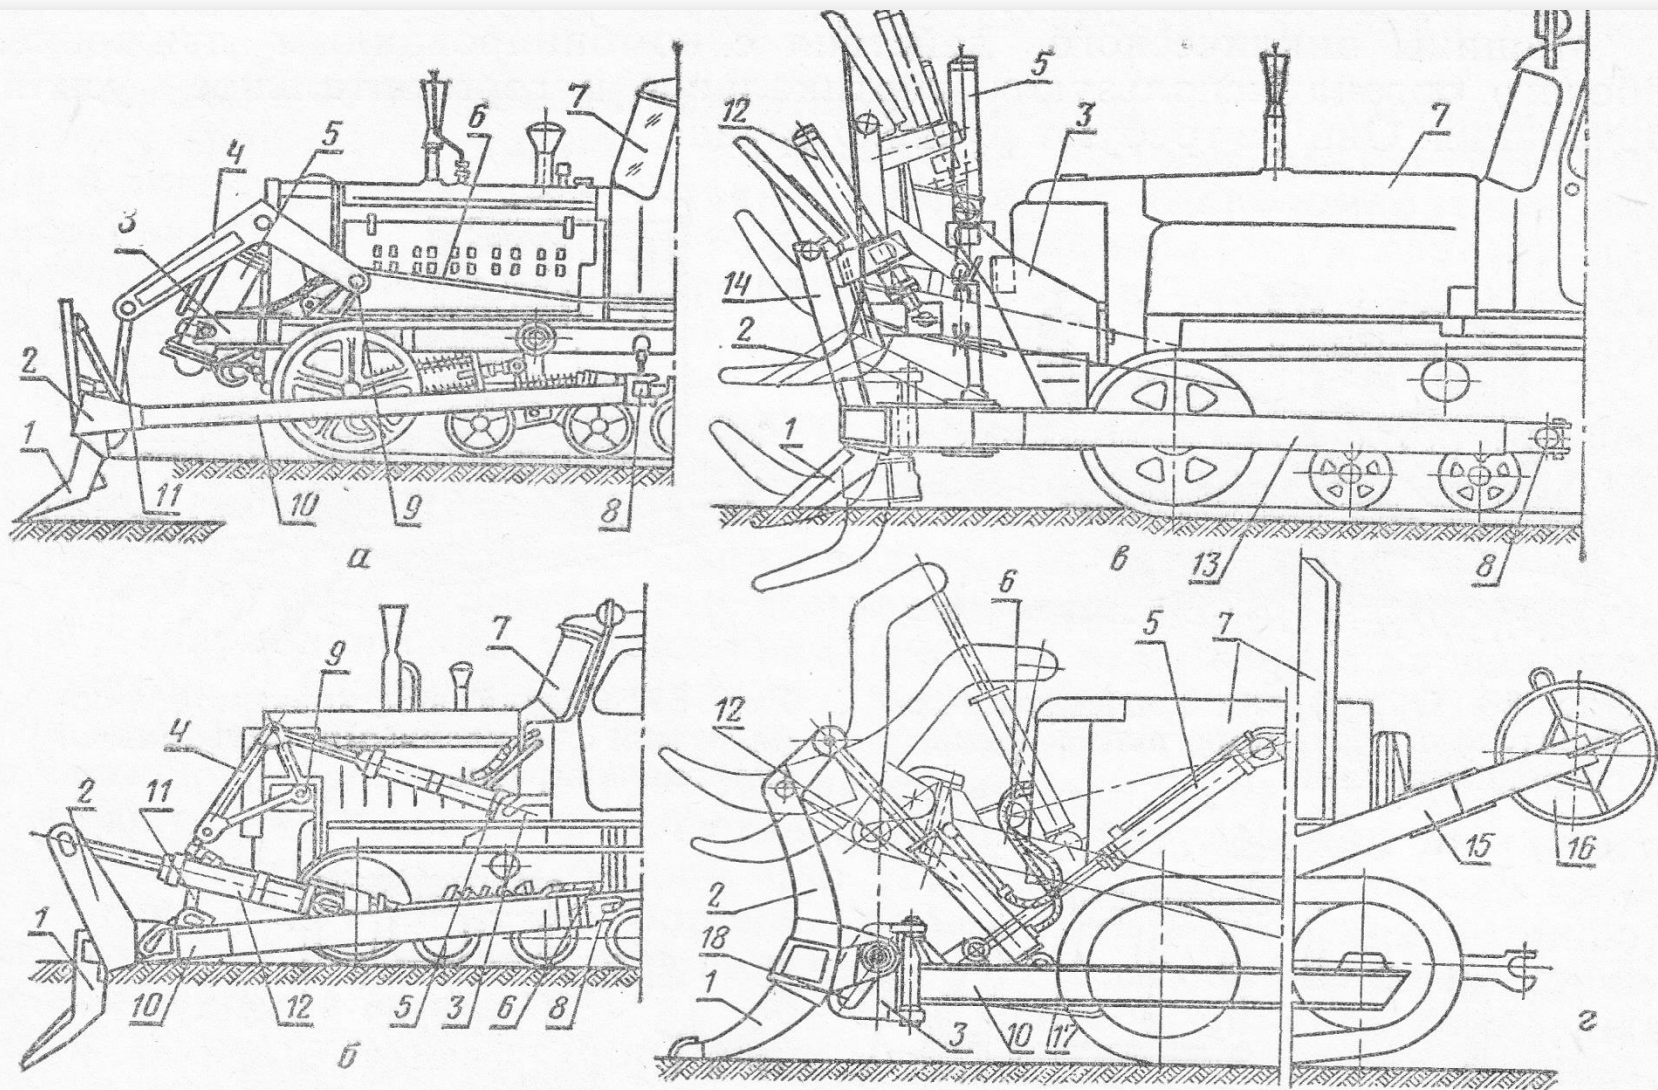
Общий вид корчевателя-собрателя с наклонными подъемными гидроцилиндрами.
